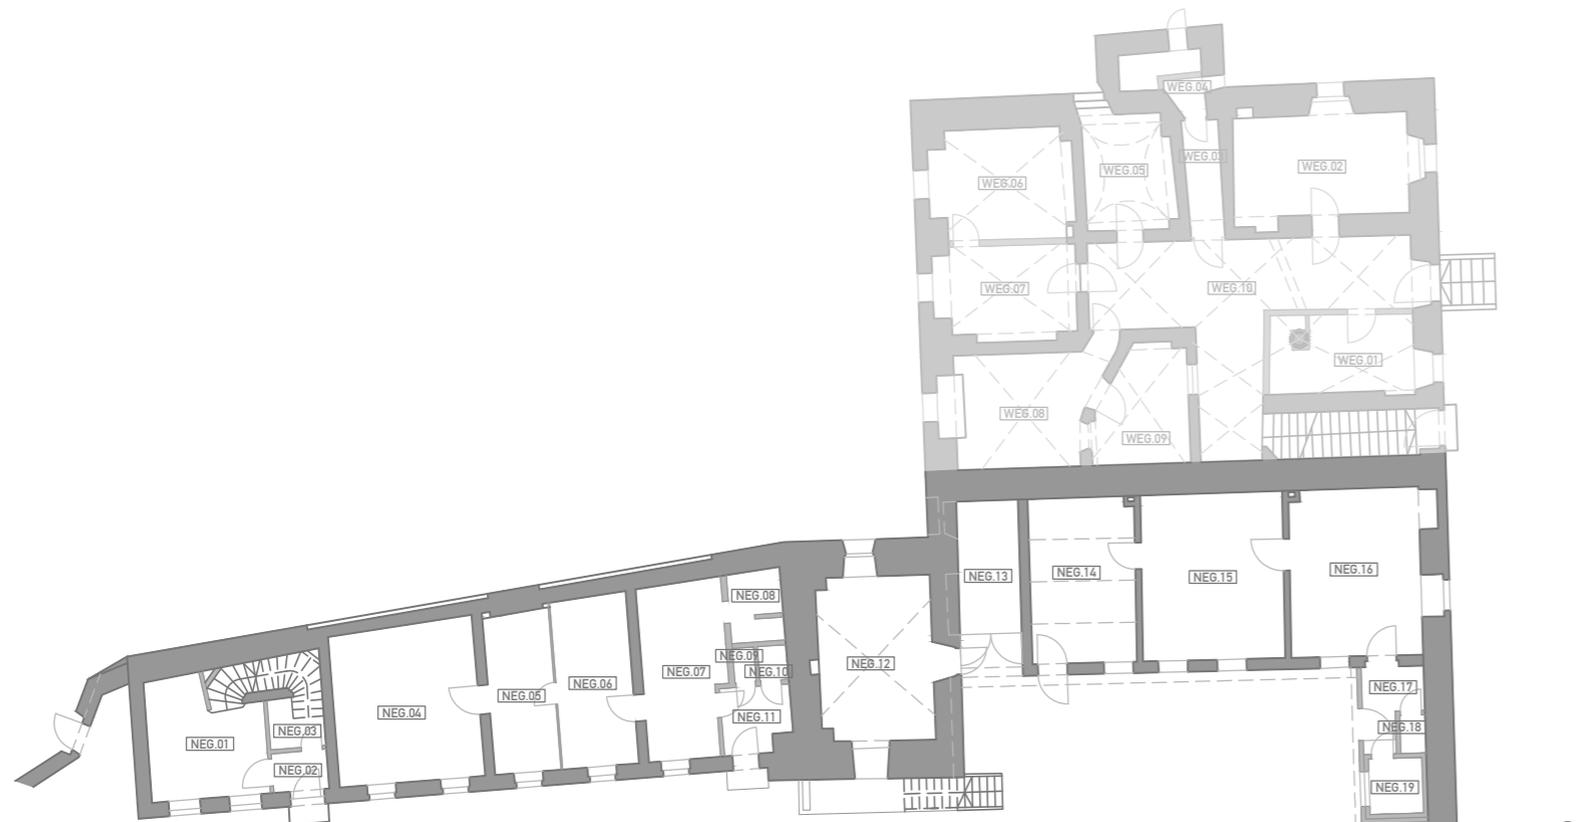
Nebengebäude Bestand Grundriss Erdgeschoß
